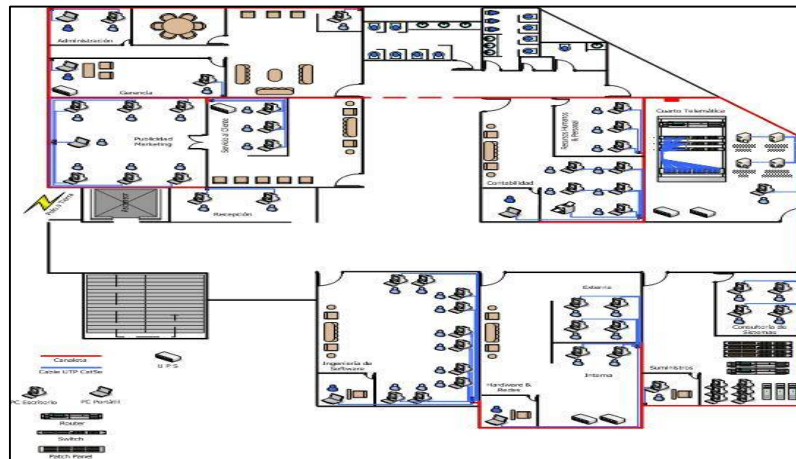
Ejemplo de Sistema de Cableado Estructurado (SCE).
